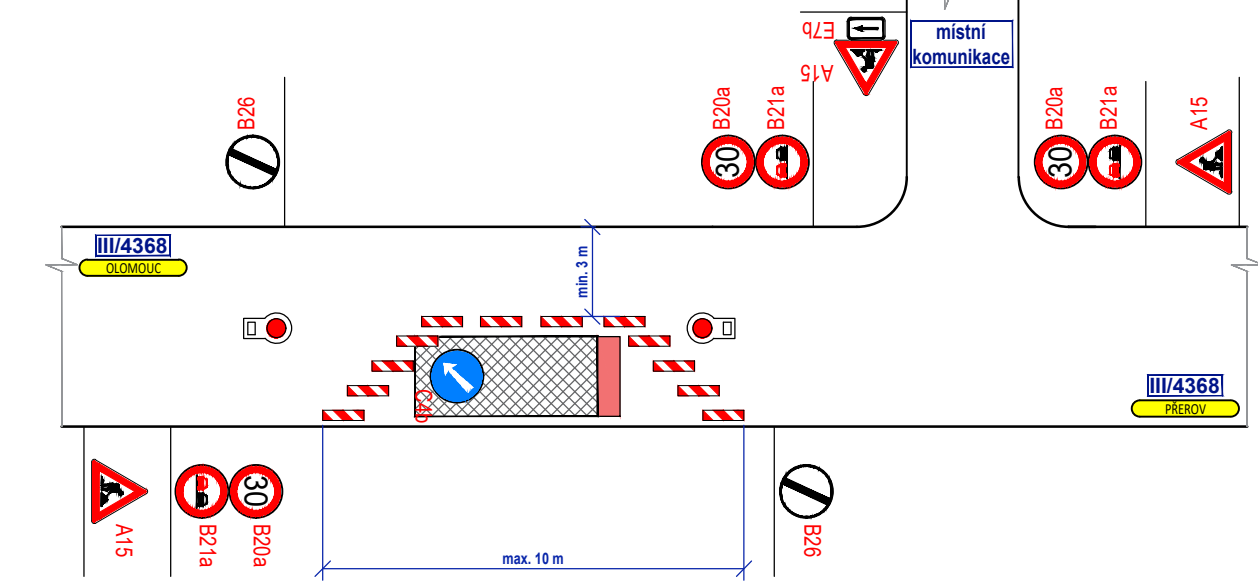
### DETAIL PRACOVNÍHO MÍSTA 4 - INTRAVILÁN
